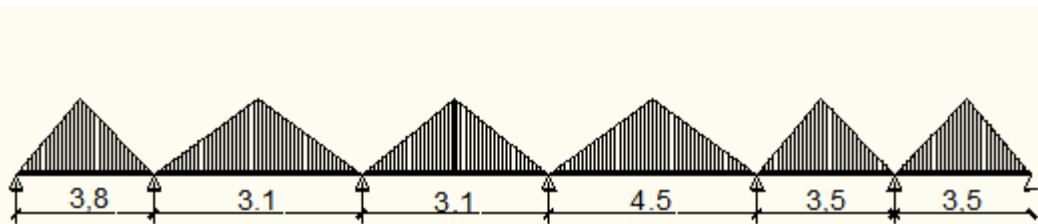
Distribution des charges sur les poutres secondaires
